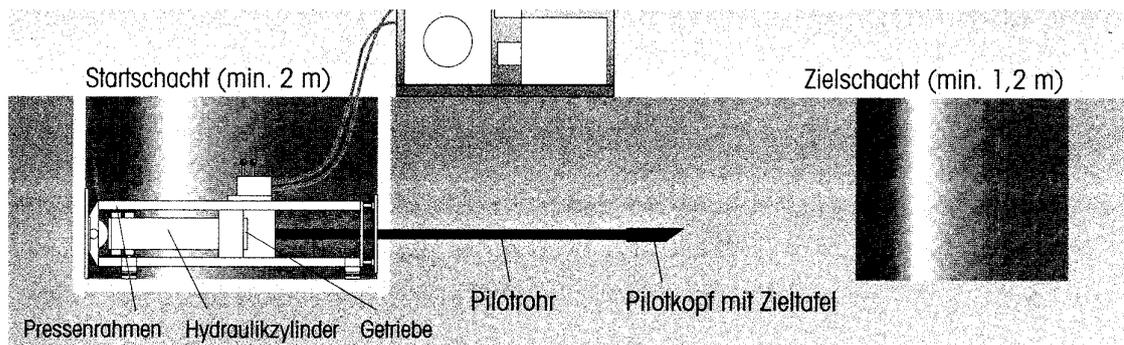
Vorpressen des Pilotrohres (gesteuert) [1]
